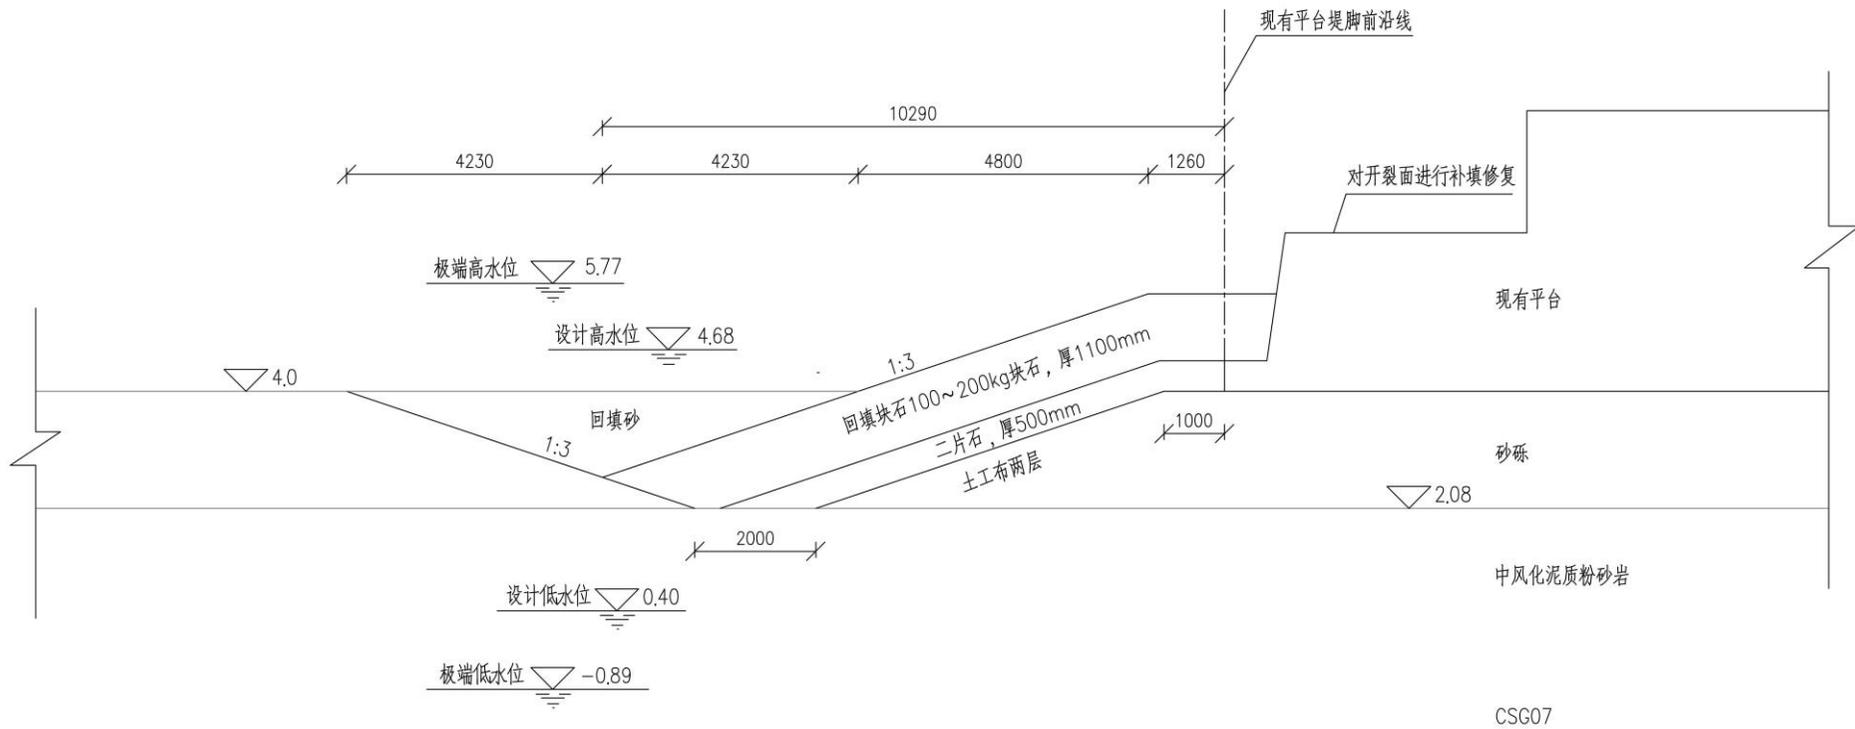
乌雷生态护坡 2 结构断面图
